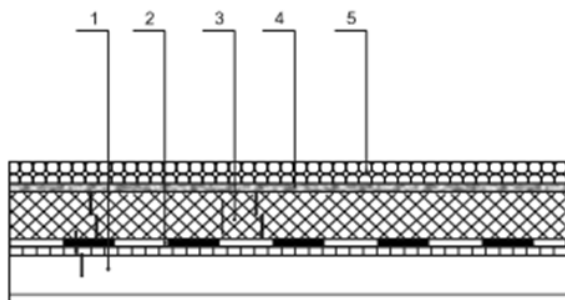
Узел инверсионного кровельного покрытия: 1 – перекрытие, 2 – гидроизоляционный ковер, 3 – утеплитель из экструдированного пенополистирола, 4 – фильтрующий материал, 5 – слой гравия толщиной не менее 50 мм
